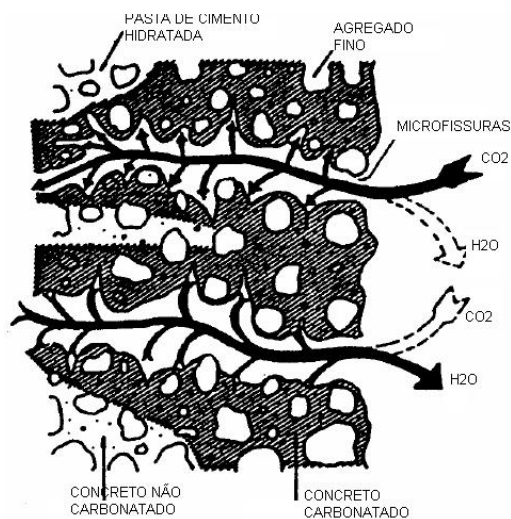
Penetração do CO_2 pela camada superficial e pelas microfissuras de uma seção de concreto
